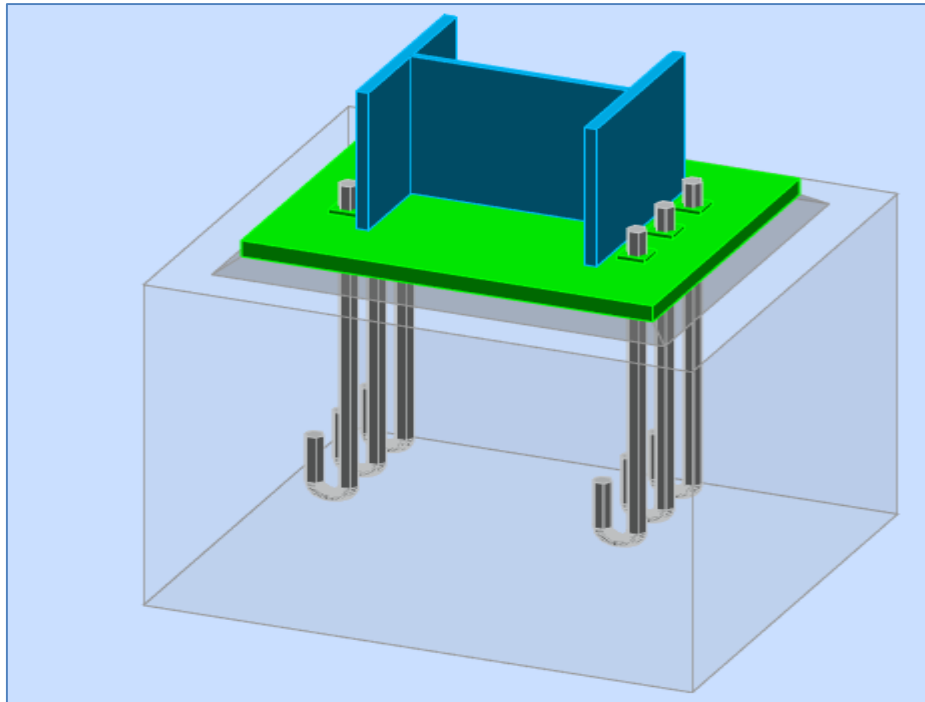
Vue 3D de l'assemblage pied de poteaux.
